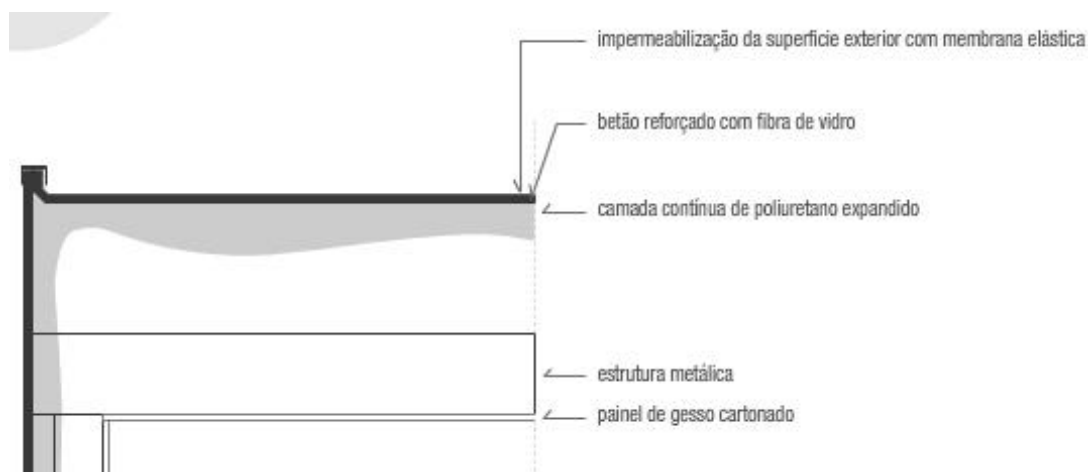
Cobertura plana em betão reforçado com fibra de vidro (SIT, 2011)
